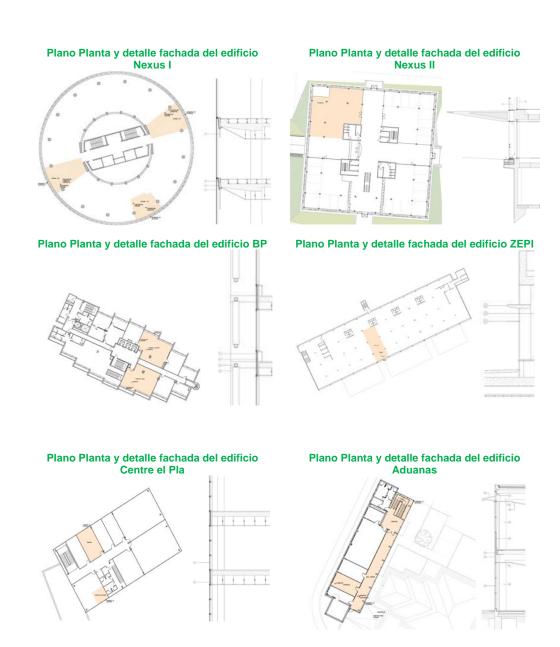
Detalles de plantas i fachadas de los ficheros de los edificios monitorizados
